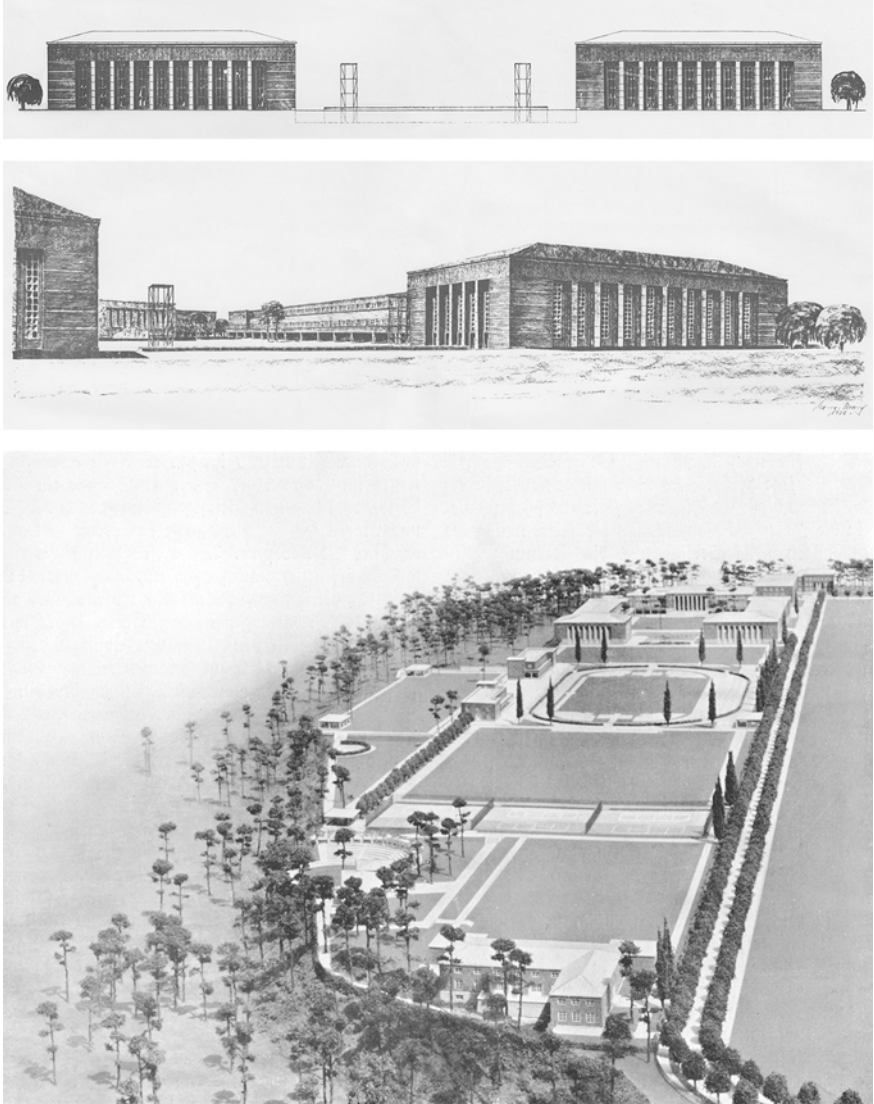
Werner March, »Deutsches Sportforum«, Berlin. Ansicht des geplanten Schwimmhallegebäudes (oben); Gebäudebezirk, Berlin, Modellaufnahme (unten)
